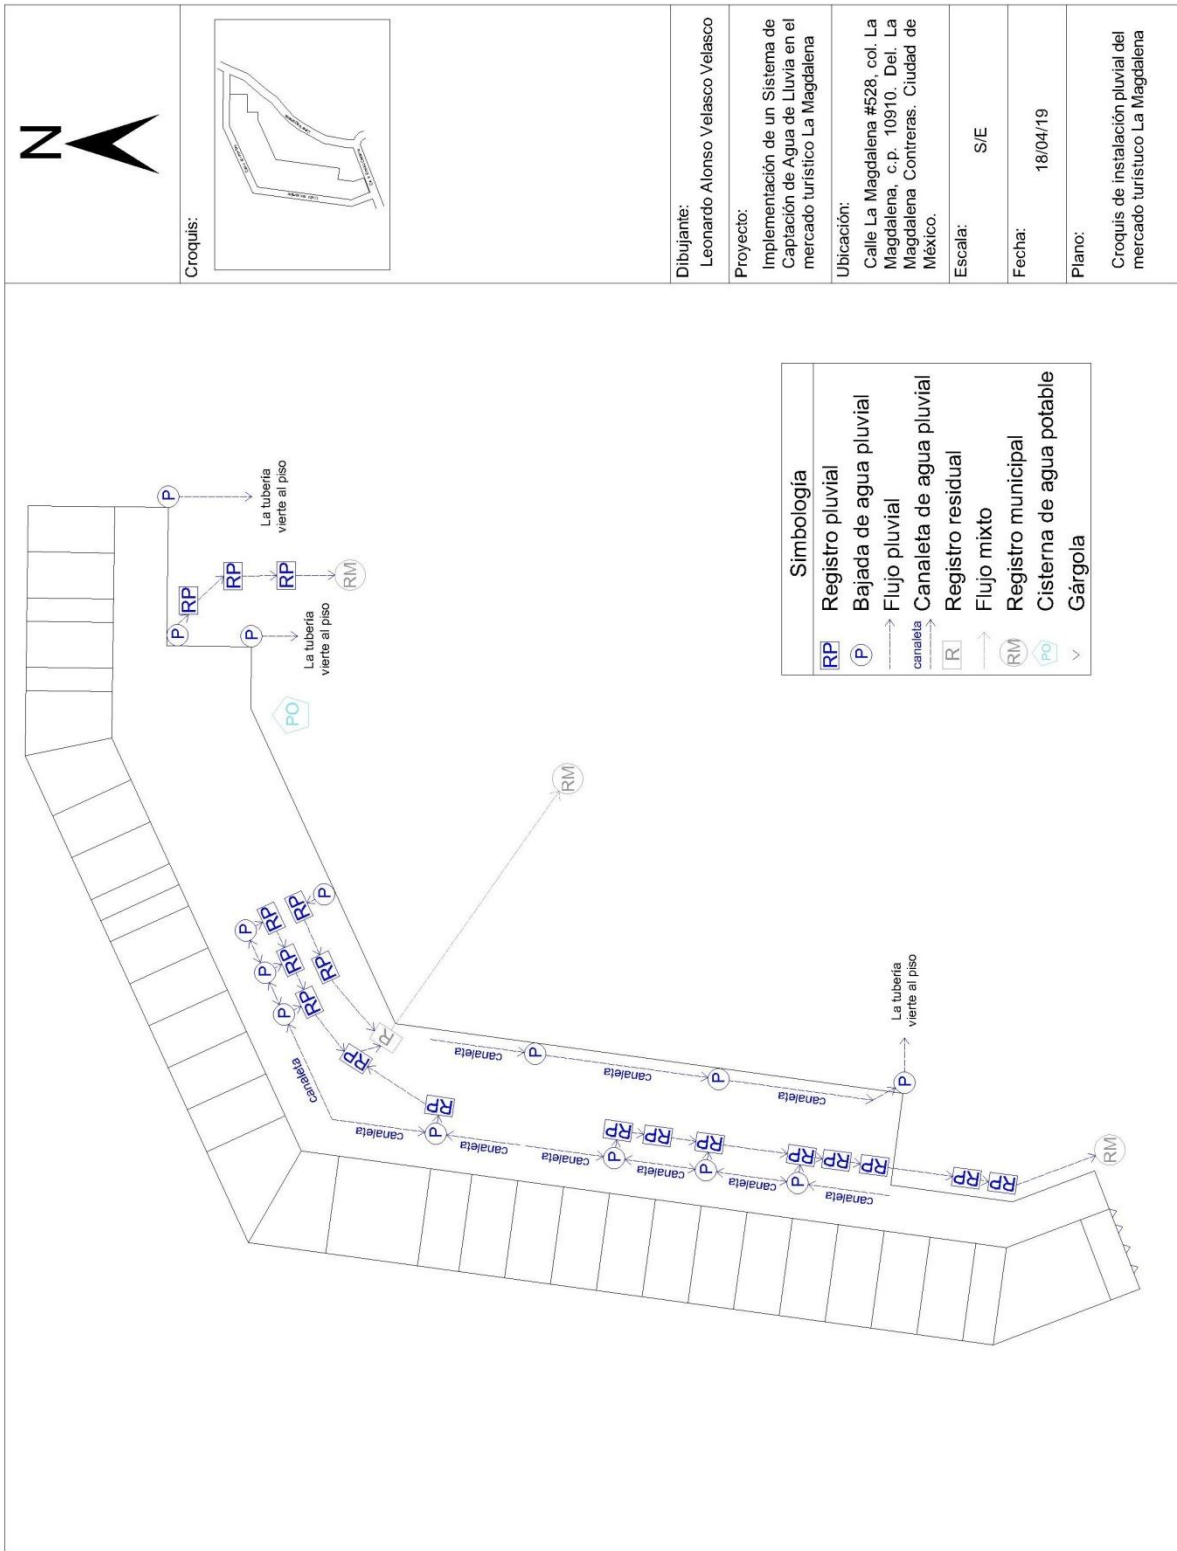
Figura VI.IV. Instalación de drenaje pluvial del mercado La Magdalena
